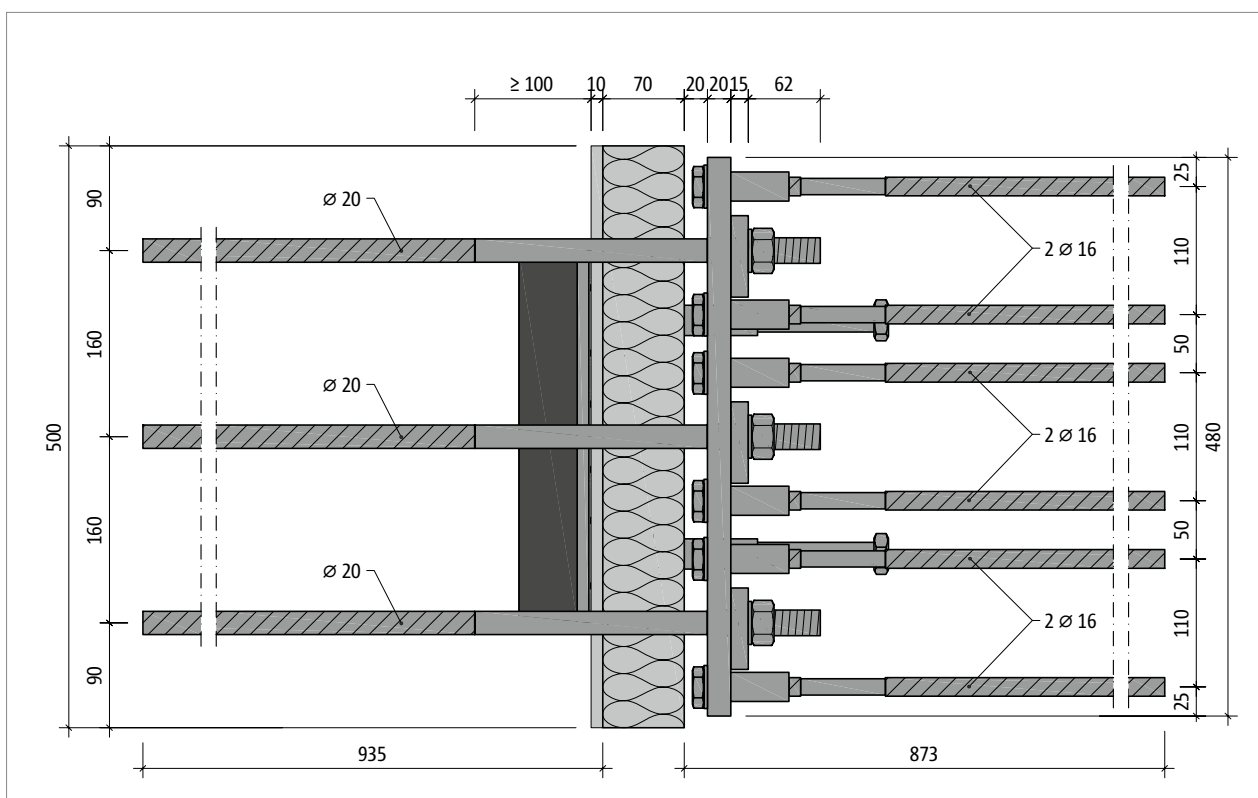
Schöck Isokorb® IQ Typ K-A: Produktgrundriss
